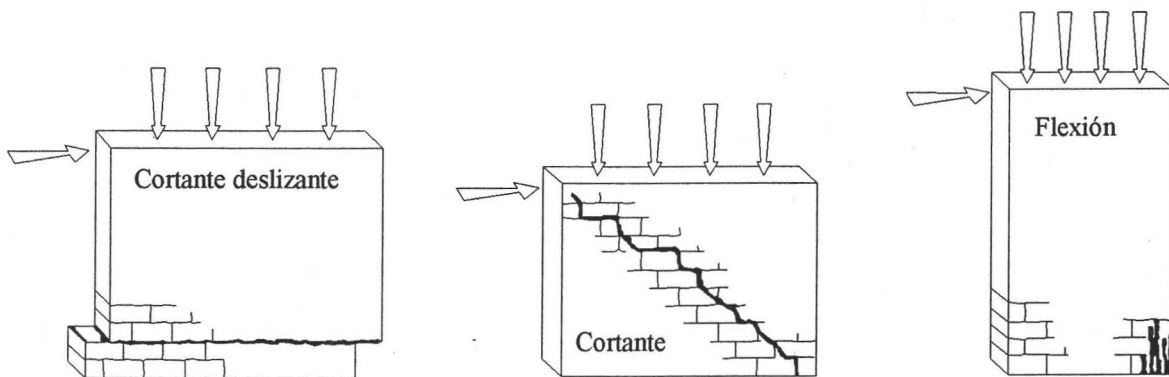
Modos típicos de falla de muros de mampostería sujetos cargas en su plano
